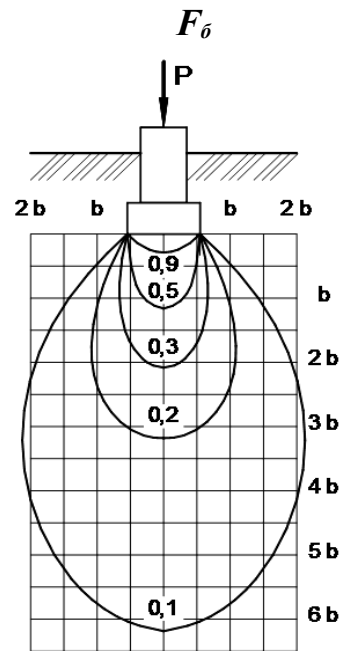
Напружена активна зона ґрунтових основ під подошвою фундаменту
